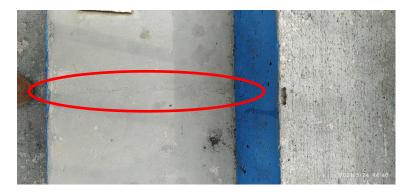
Fisuras en graderías - OCI 24-03-2021
